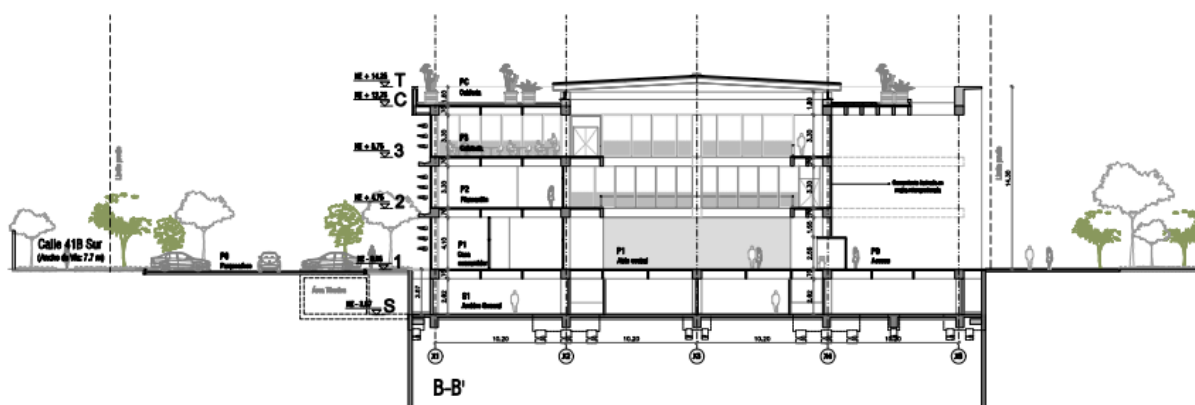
Corte Longitudinal. Fuente: Planos arquitectónicos.
